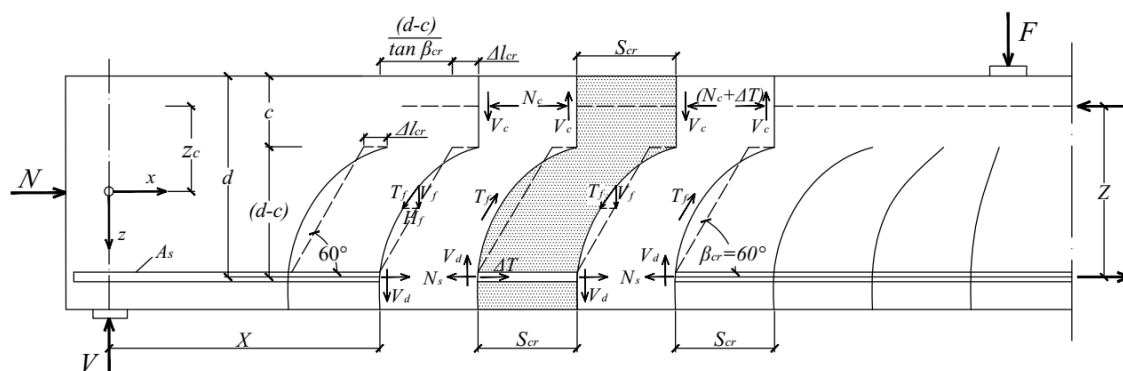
Железобетонная конструкция с «зубчатыми» элементами [1]
